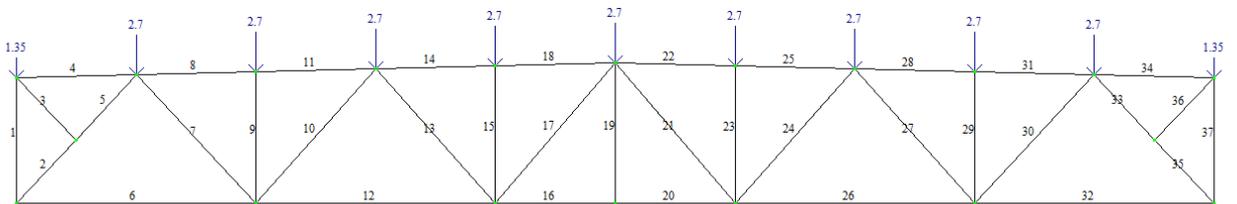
Загрузка 3 (снеговая нагрузка на весь пролет фермы)
